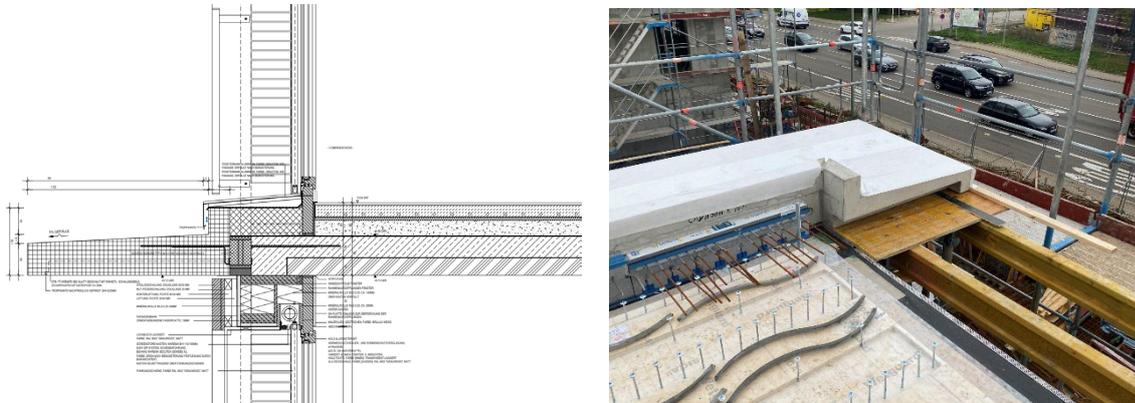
+12: Links: Detail Betonkrempe; Rechts: Beton-Krempe im Rohbauzustand, zusätzlich zu sehen sind die Iso-Körbe, welche die Verbindung zwischen HBV-Decke und Betonkrempe gewährleisten
